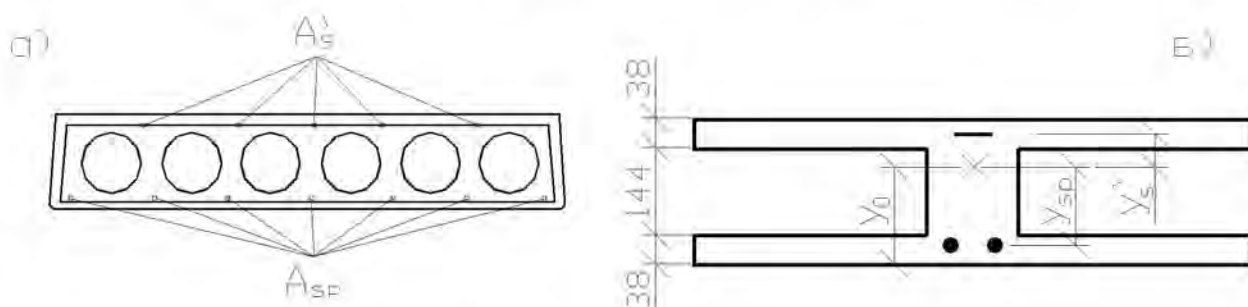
Плита перекрытия: а) армирование; б) расчетное сечение плиты для 2-ой группы предельных состояний.
